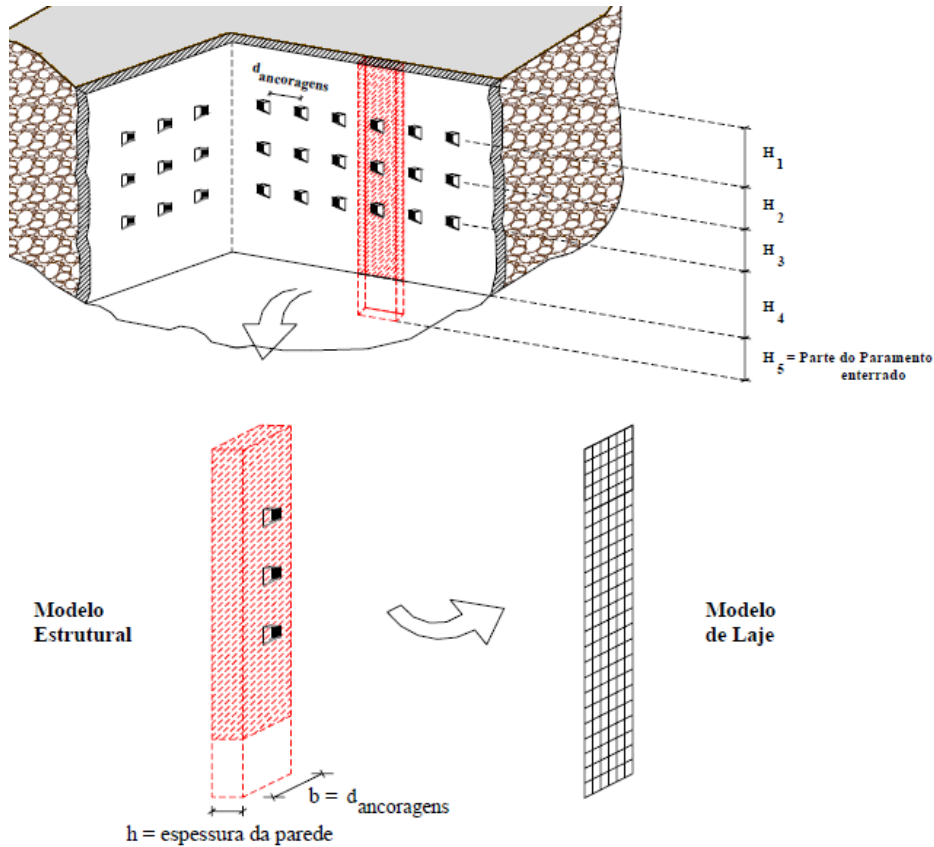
Modelo Laje (Sousa, et. al, 2006)
